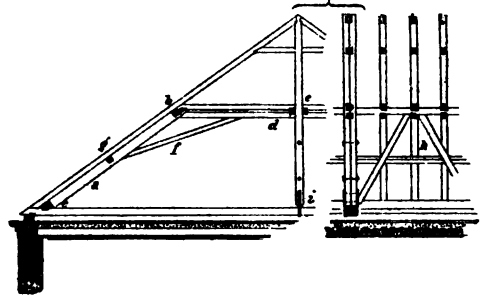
Querschnitt eines liegenden Dachstuhles. a Stuhlsäule, b Pfette, c Schweller, d Brustriegel, e Durchzugbalken, f Strebe (Zagband), g Dachwandriegel, h Dachwandbänder, i Hängsäule.
